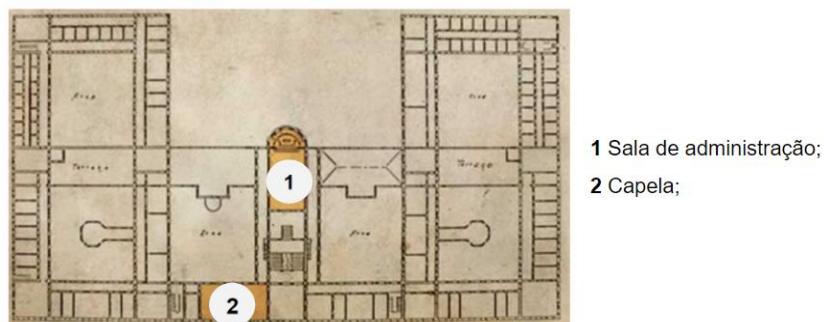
Planta baixa do 1º pavimento do Hospício Pedro II
